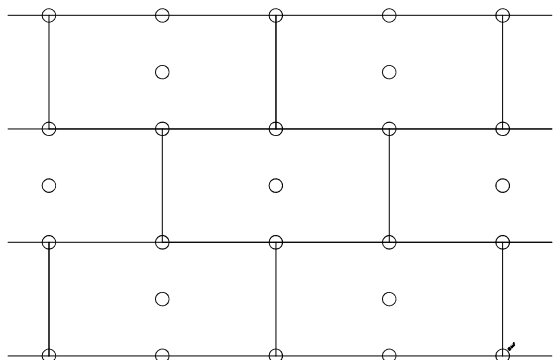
OPLÁŠTĚNÍ MEZIOKENNÍCH PILÍŘKŮ PŮDORYS (M 1:5)
